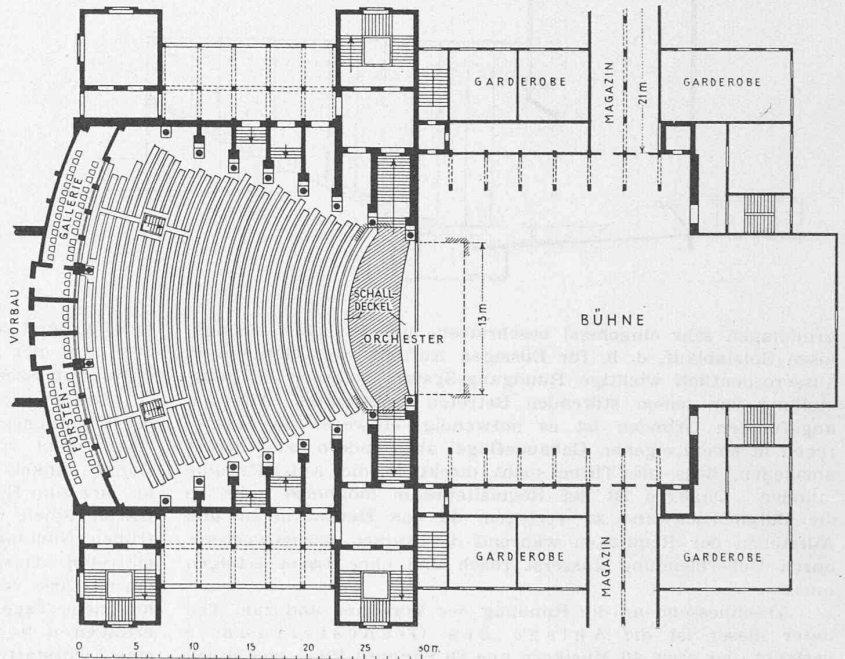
Das Bayreuther Festspielhaus mit ursprünglicher Treppenanlage. Grundriss 1 : 600
